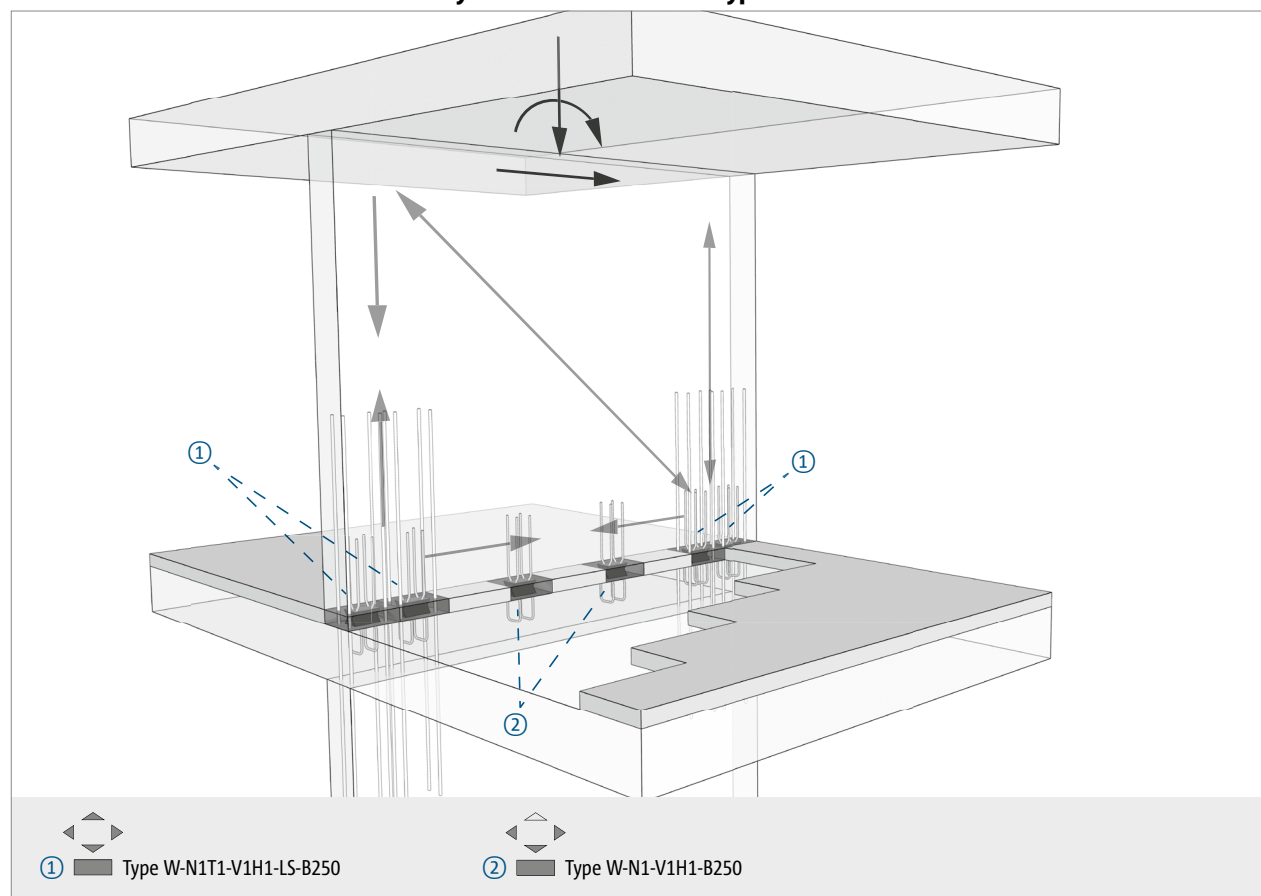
Mur de stabilisation du bâtiment sur la dalle, désolidarisé
